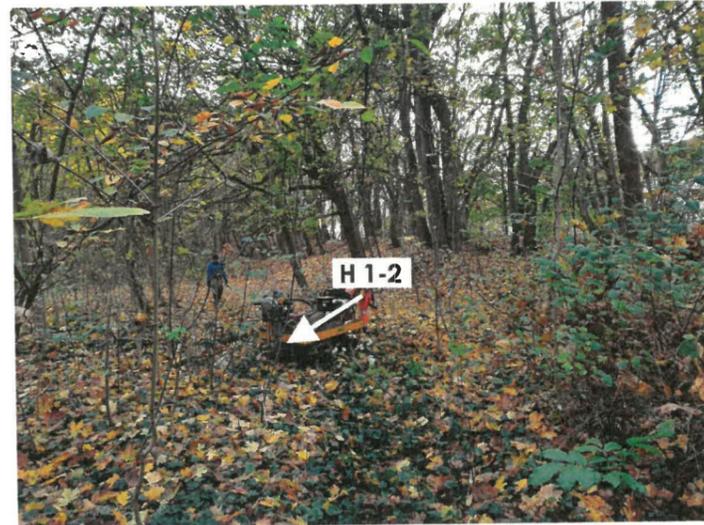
Position H 1-2 im nordwestlichen Teil des Grundstückes
